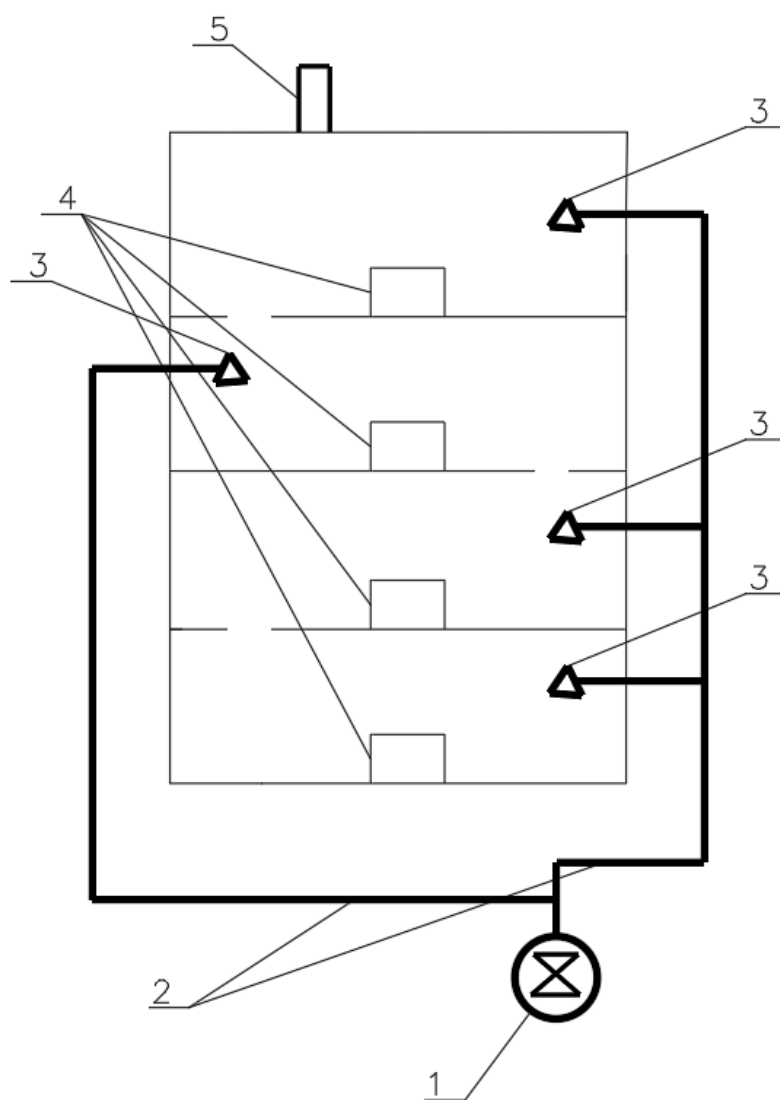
Схема экспериментальной установки: 1 – вентилятор; 2 – воздуховод; 3 – воздухораспределительное устройство; 4 – теплоventильатор; 5 – естественная вытяжная вентиляция
